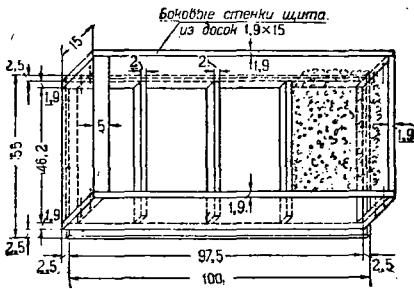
Перекрытие поперечных пивов при двойном утеплении
